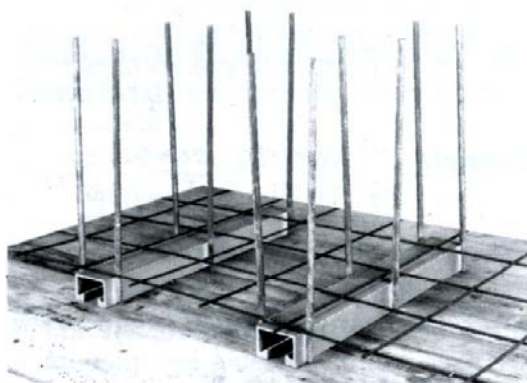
Seitlich angeschweißter Betonstabstahl (P5)
